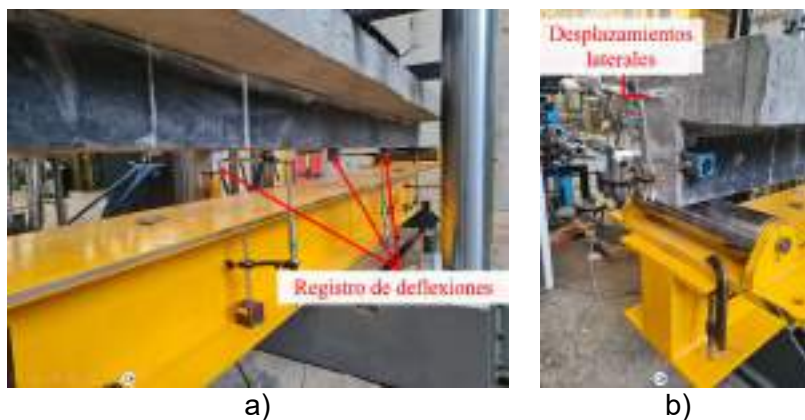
Montaje del ensayo experimental ensayos a flexión en vigas.
